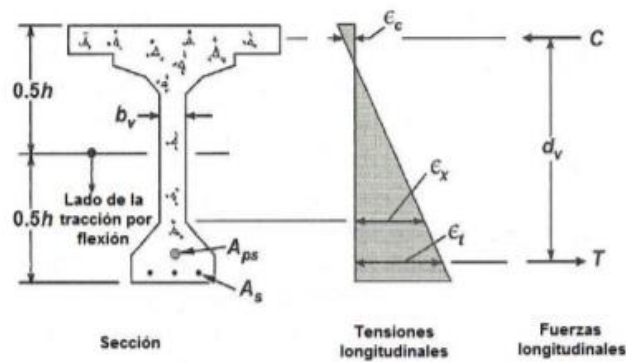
Deformación Longitudinal, ϵ_x , para Secciones con menos del Mínimo del Refuerzo Transversal
